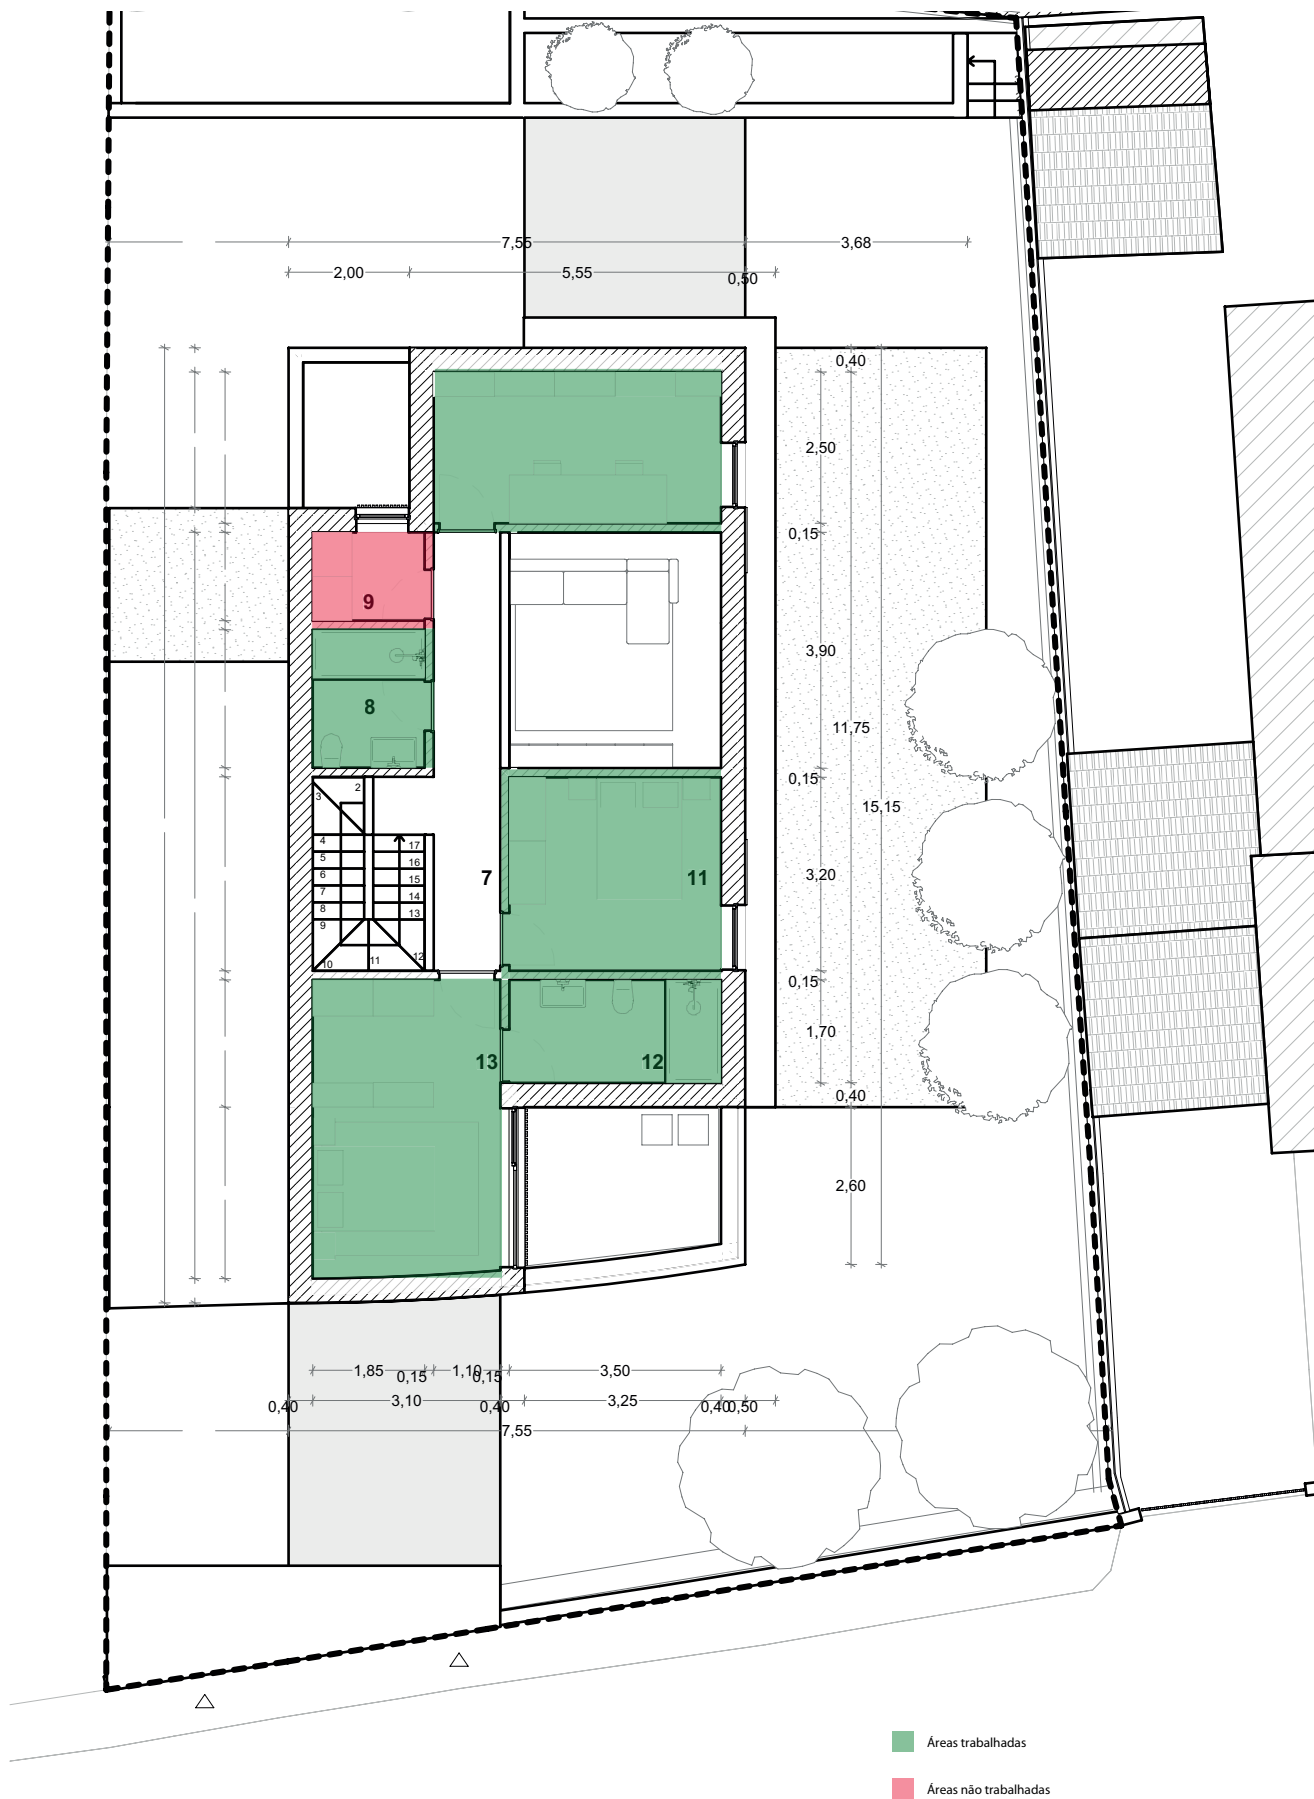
Planta rés/chão com áreas trabalhadas e não trabalhadas.
